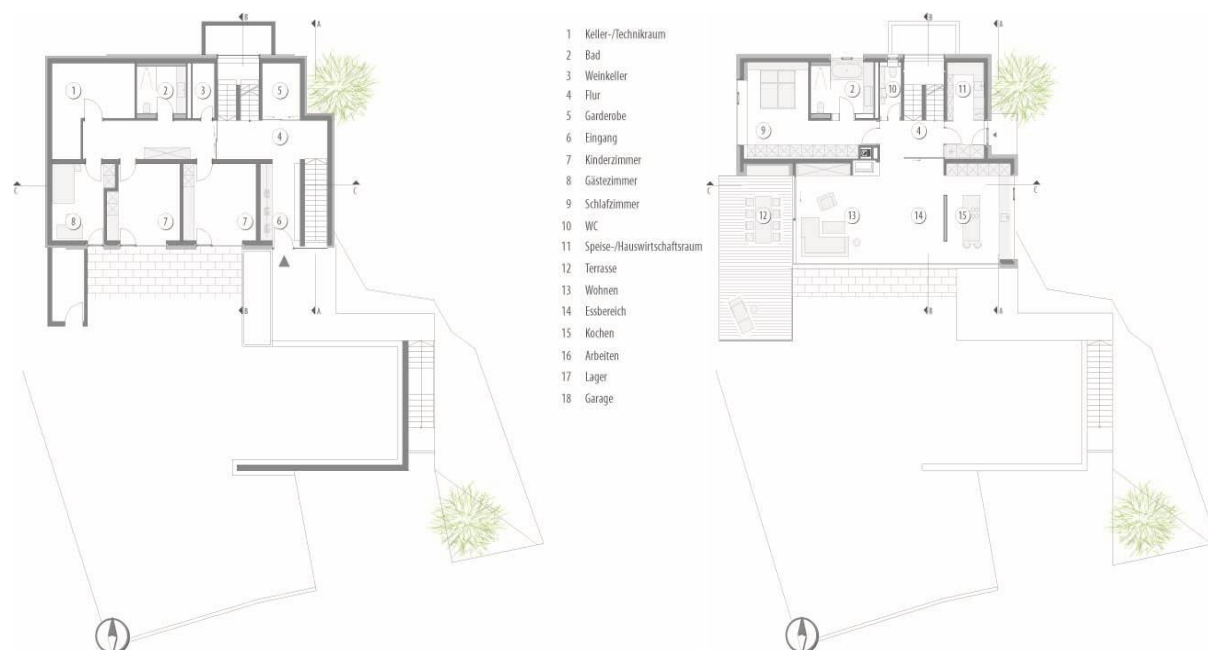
Grundriss Erdgeschoss (links) und 1. Obergeschoss (rechts) (Architekt: Berschneider und Berschneider, Pilsach)
